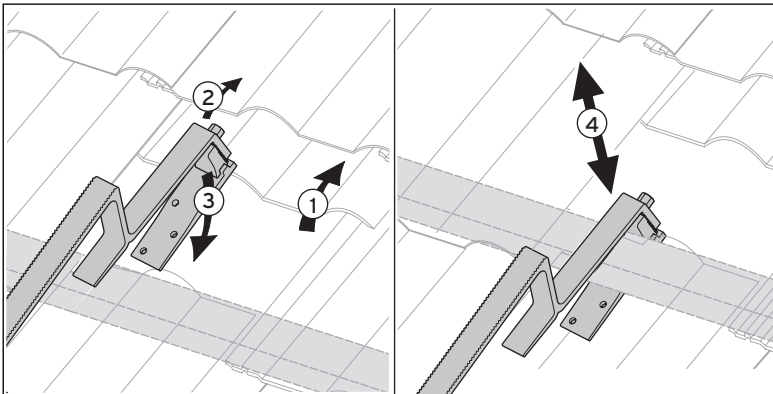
Position des Dachankers Typ P auf der Dachlatte festlegen
